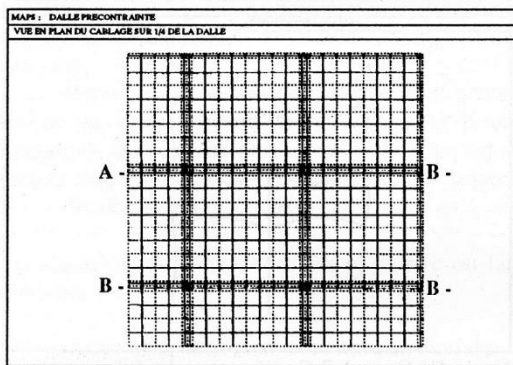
Vue en plan du système de câblage pour un quart de la dalle (on remarquera le resserrement des câbles au-dessus des piliers).
